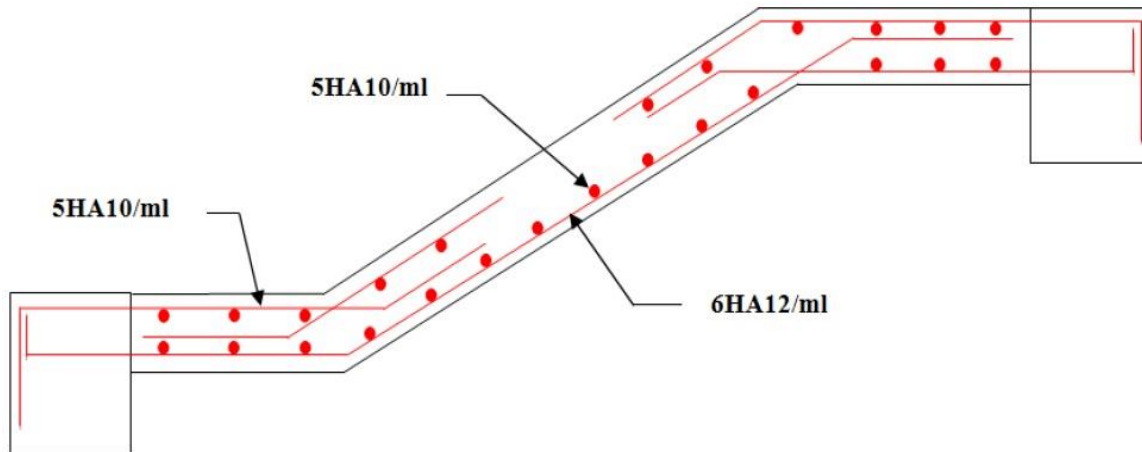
Schéma de ferrailage de la partie AB de l'escalier.
